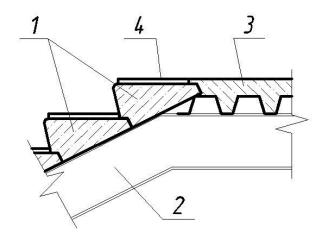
Внутренняя лестница: 1 – сборные железобетонные ступени; 2 – металлический косоур из швеллера №24; 3 – железобетонная площадка лестницы по несъёмной опалубке; 4 – накладная проступь
